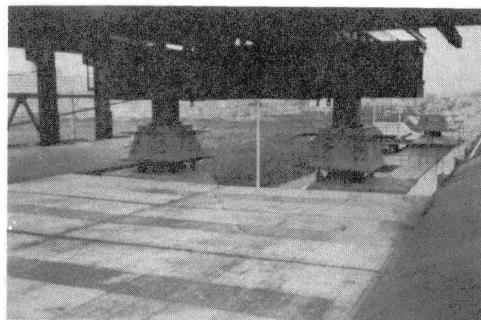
前方橋脚上に作業されたコンクリート・ブロック
